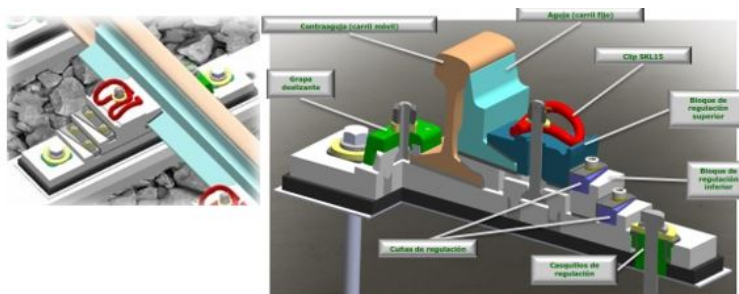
Detalle de placa de deslizamiento para aparato de dilatación
